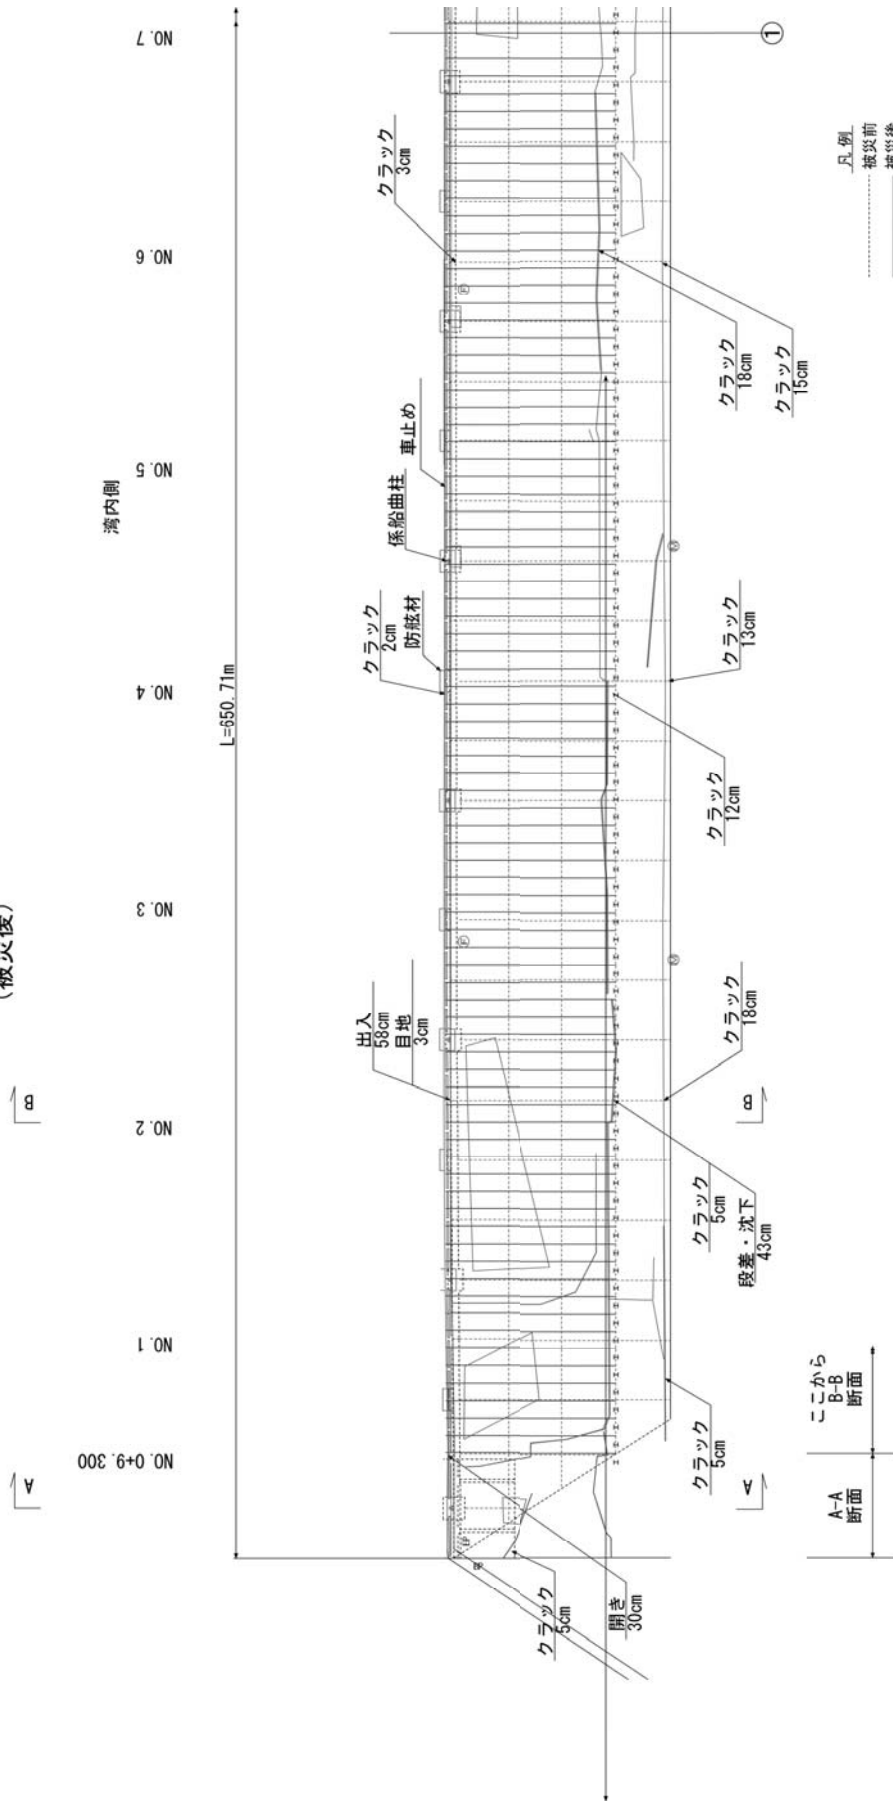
(a) 箱崎埠頭-7.5m 岸壁の被災状況詳細平面図
